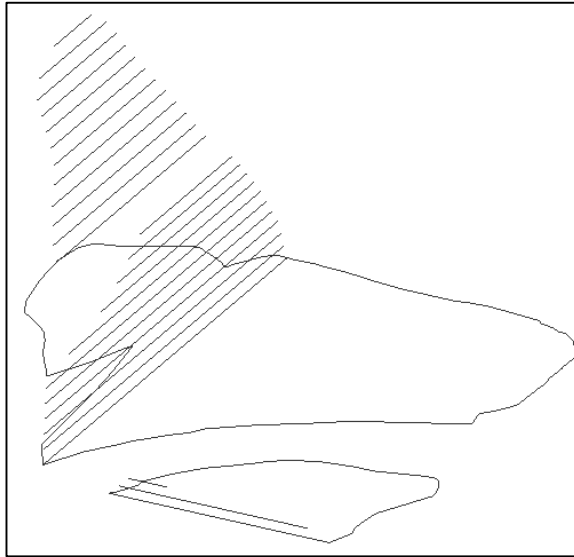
Contornos de las excavaciones de la zona de casa de máquinas
